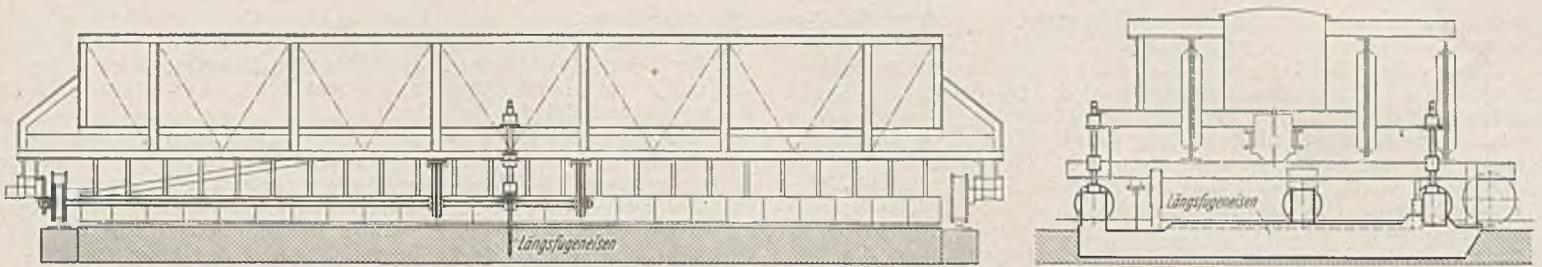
Längsfugenschneider in einem Hammerfertiger für Betondecken.
